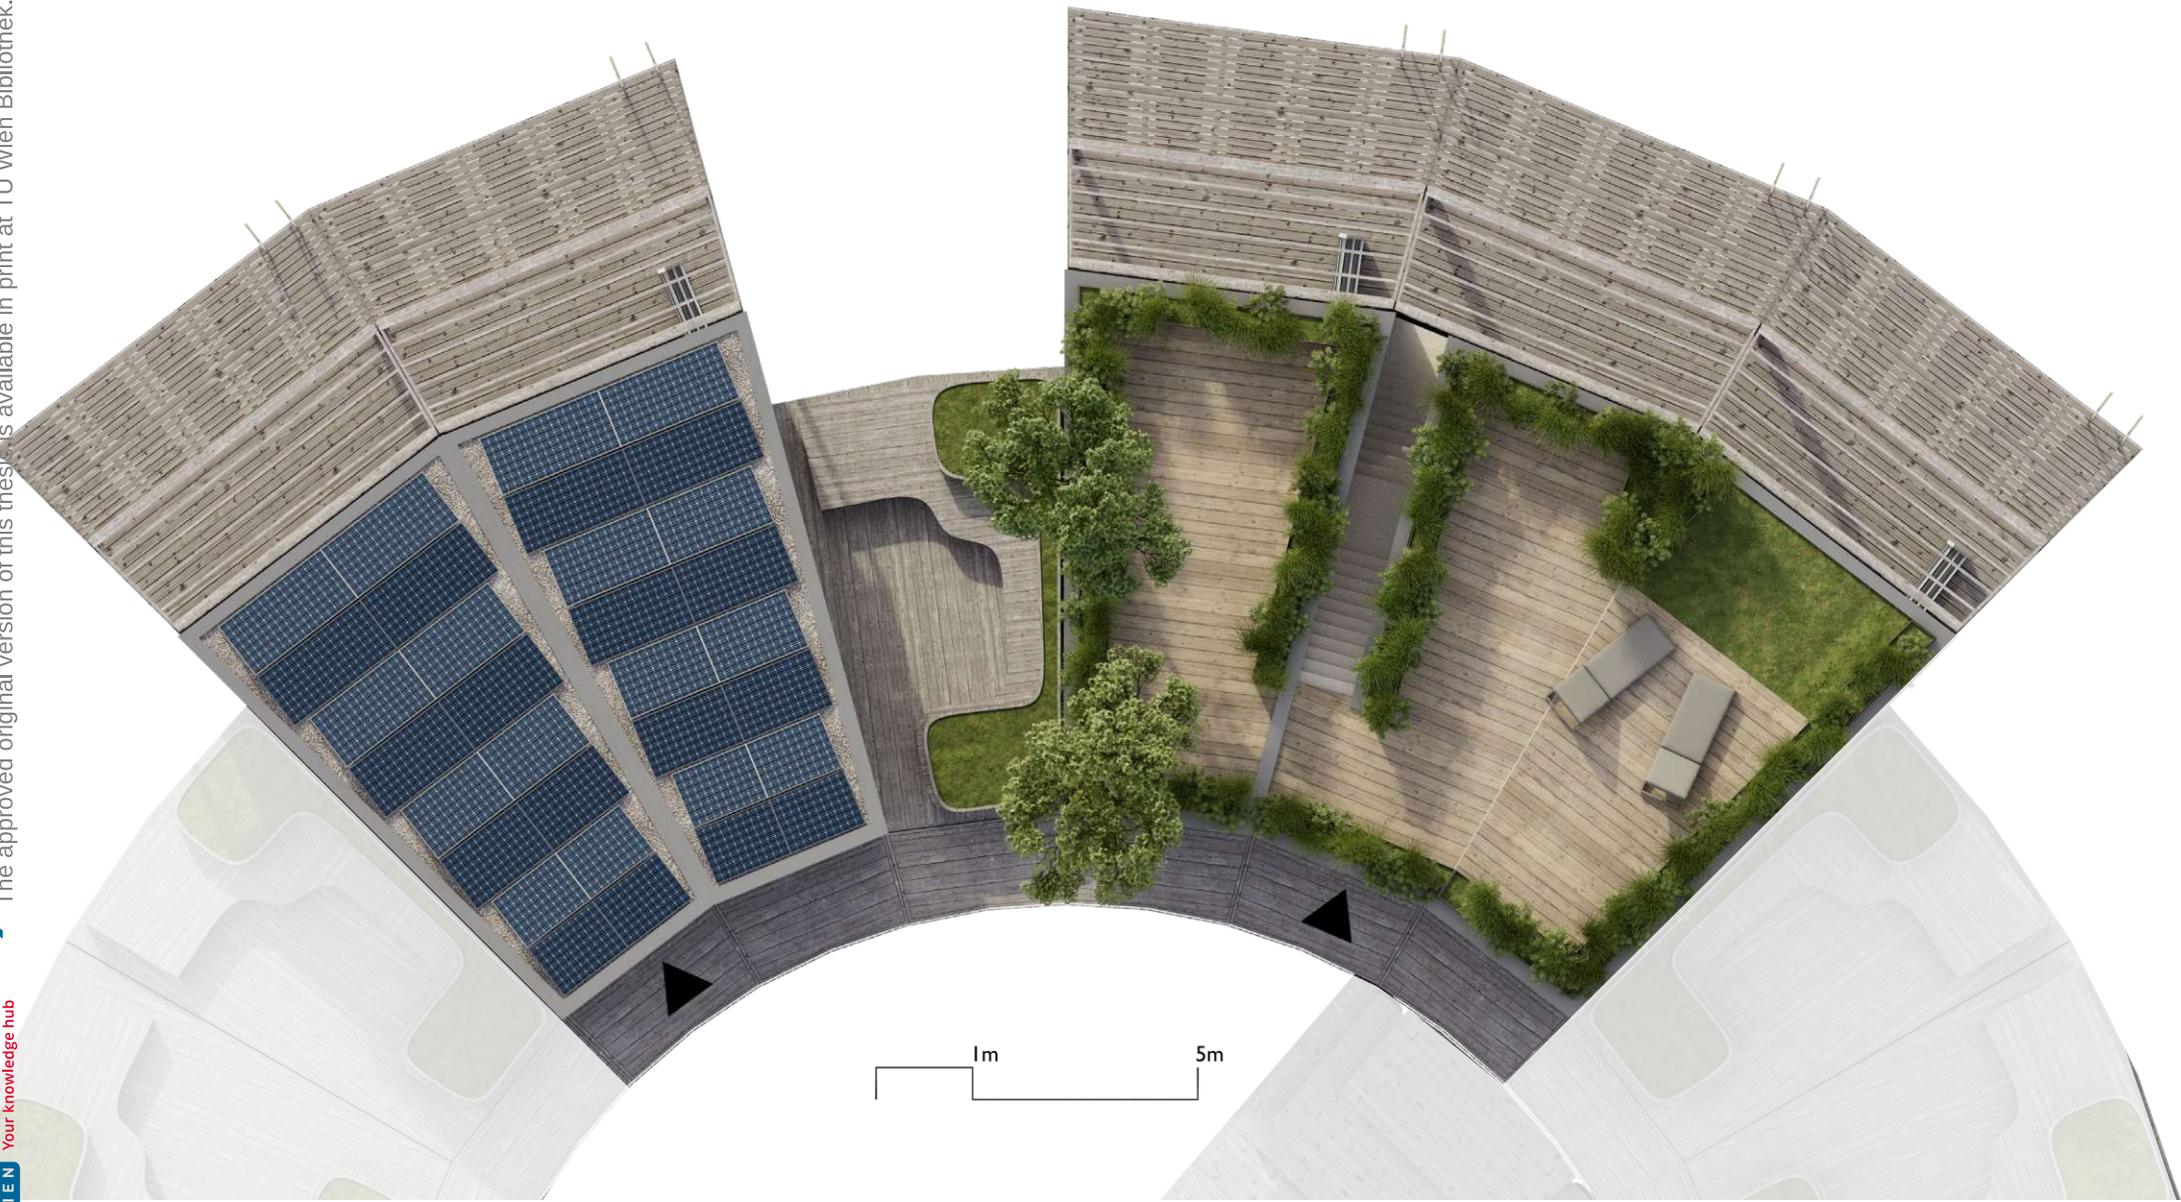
Grundriss-Variante A (60m²) und Grundriss-Variante B (90m²) - Solar-Dach/ Dachterrasse (von J.C. Aurel)
